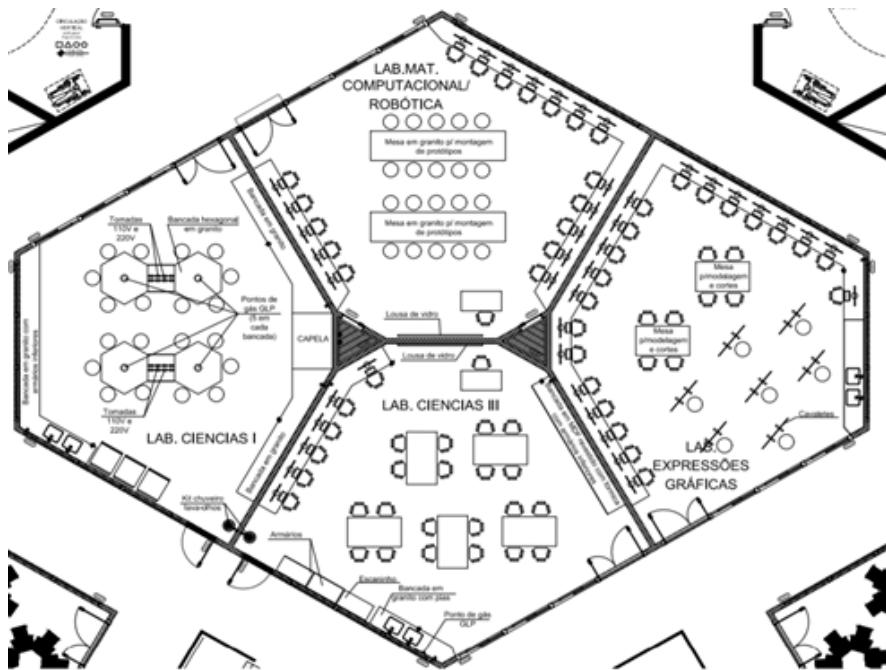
Planta laboratórios pavimento 2 (Bloco Pedagógico).
